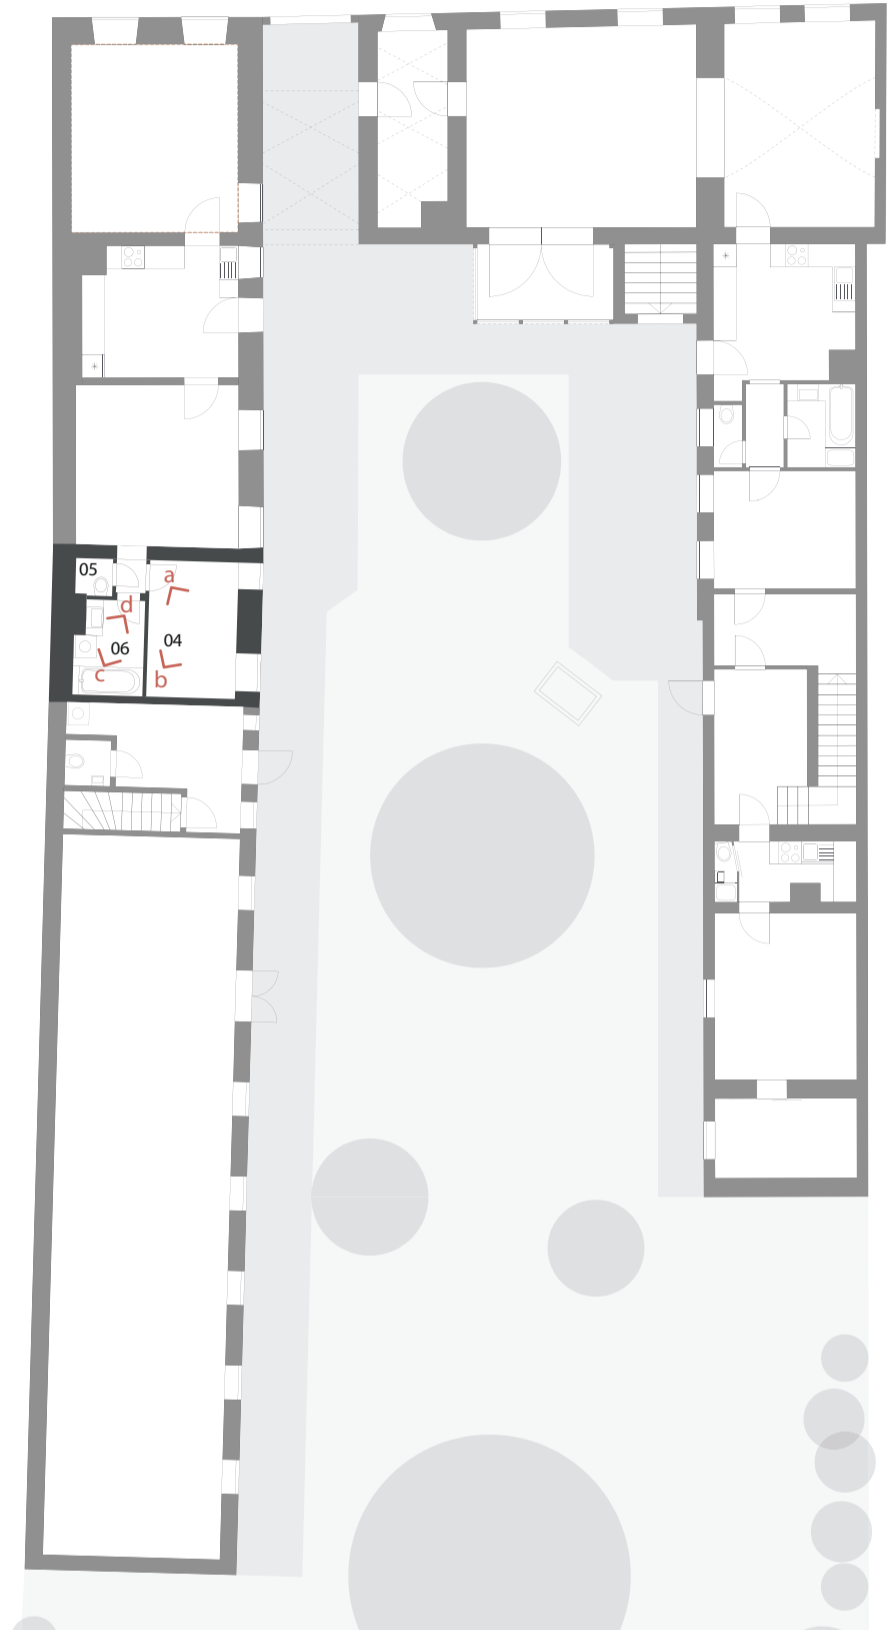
Grundriss Erdgeschoß | M 1:200 | Raum 04, 05, 06
